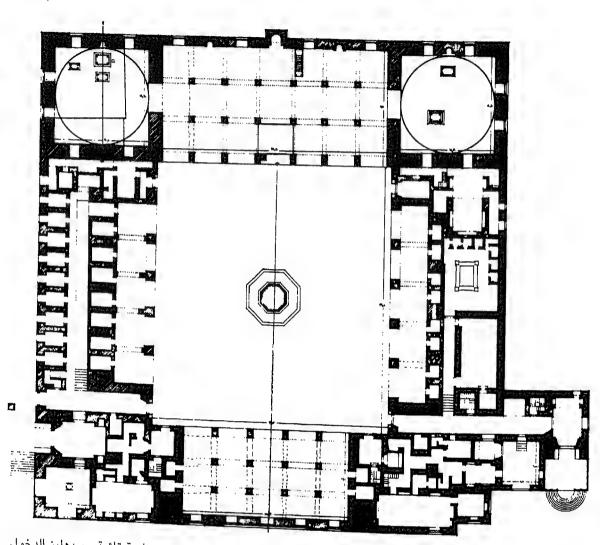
٤ _ مسقط أفقى لجامع الأقمر
